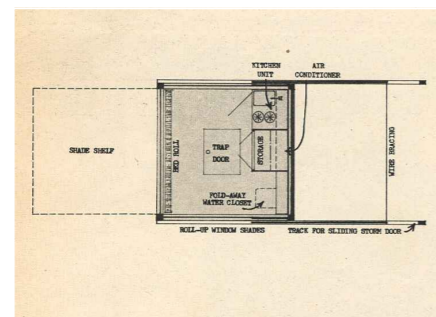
| Planta do projecto da Esquire Weekend House.
